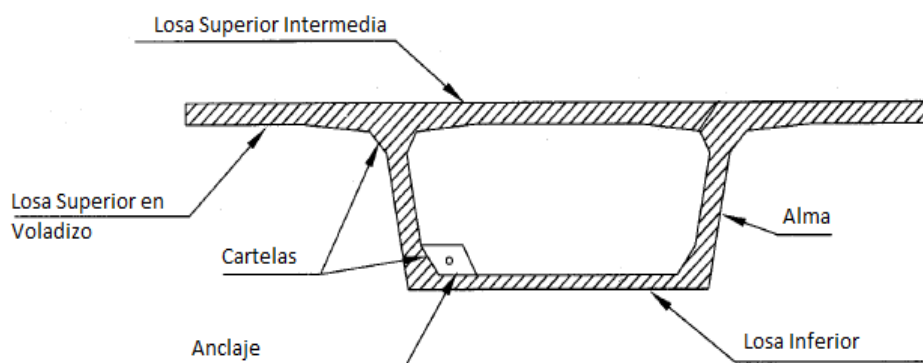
Sección transversal cajón y sus elementos. Adaptado de [17]
